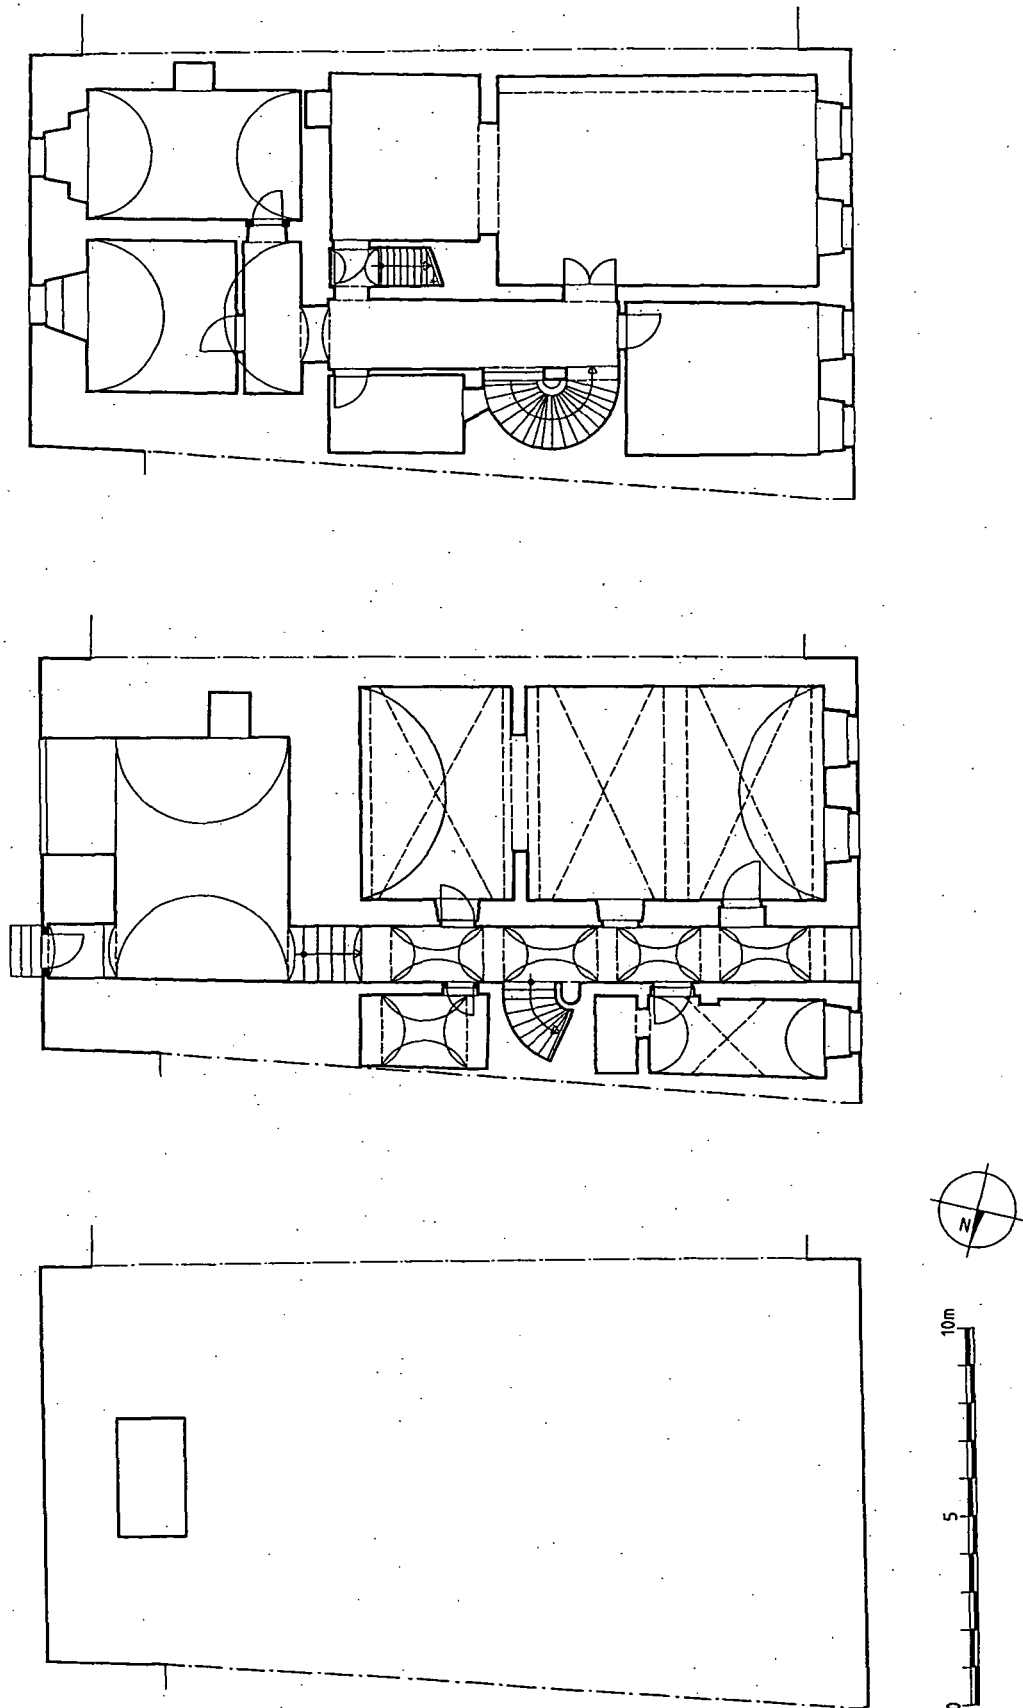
Stadtplatz 13 – Grundrisse Keller, Erdgeschoss, Obergeschoss (1:200).
